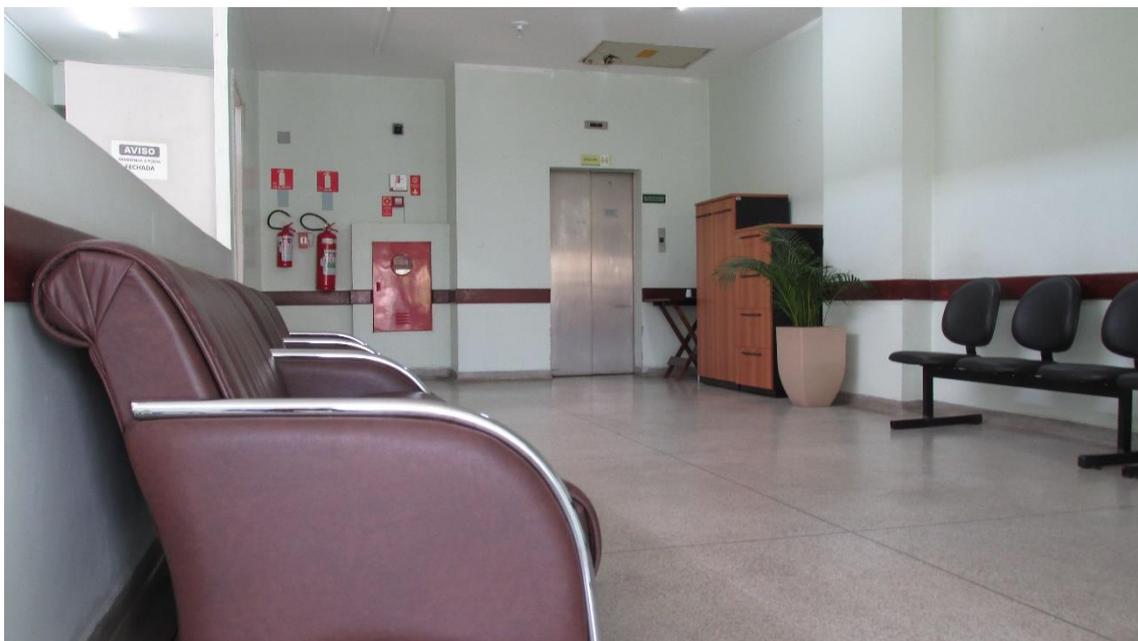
2º pavimento do Bloco A, com Hall do elevador. Se liga às unidades do Hospital por rampa. Nesse pavimento ficarão os ambientes administrativos e apoio técnico (TI e Engenharia Clínica).
